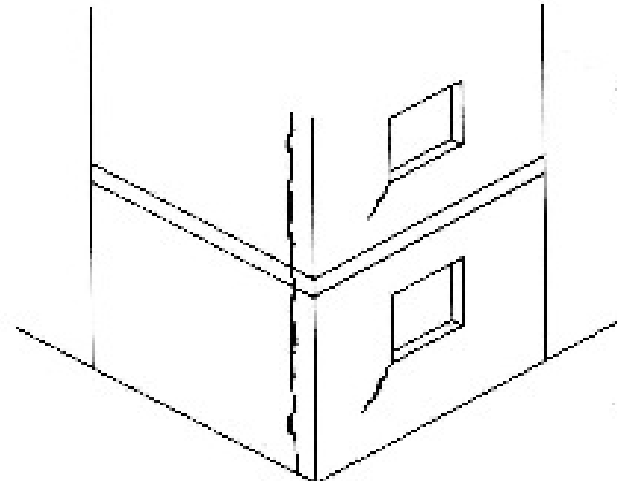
Fissuração vertical da alvenaria devido à absorção de umidade do tijolo. (THOMAZ, 1989)
